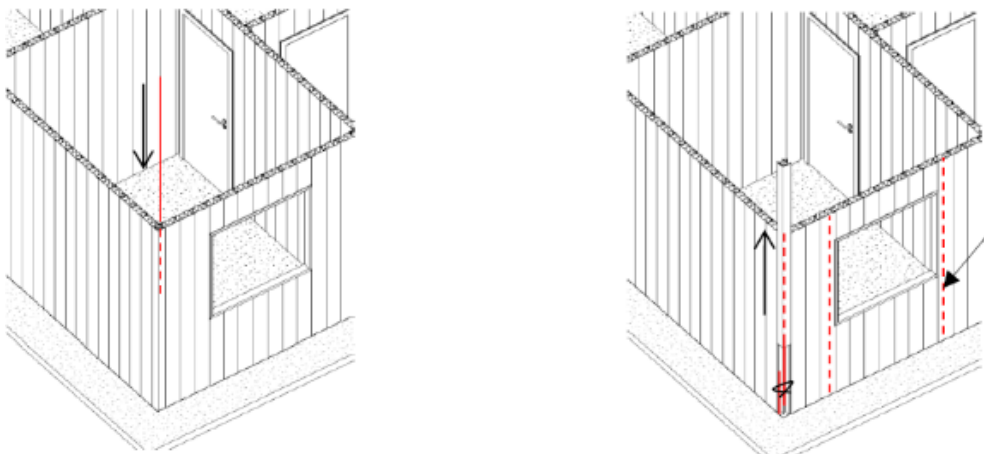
Ilustração da inserção da barra de armadura vertical e posterior elevação do perfil “Curva 90°” para amarração da barra de armadura vertical à armadura de ancoragem parede-fundação. (Sem escala).
